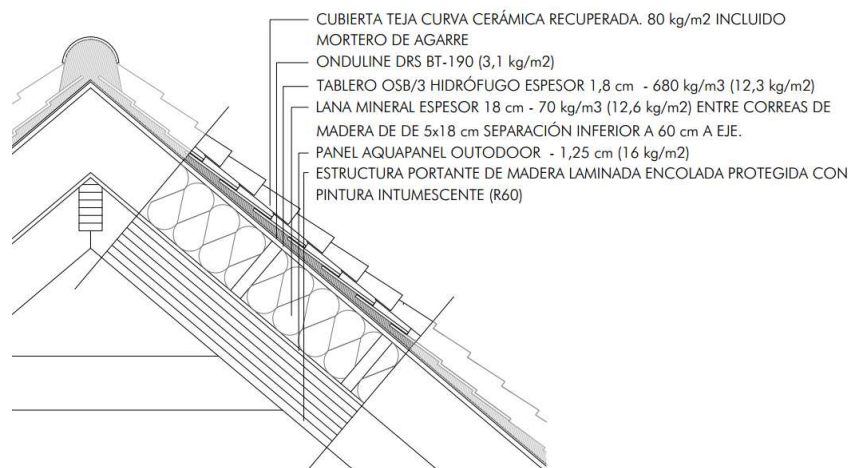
Sección constructiva faldón cubierta inclinada
